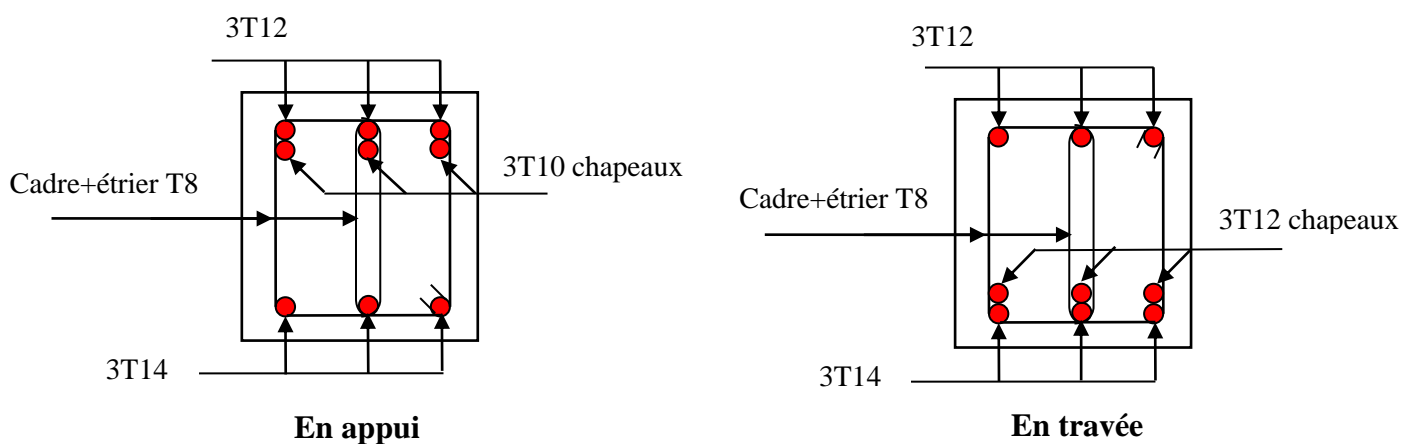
Schémas de ferrailage des poutres secondaires suspente
